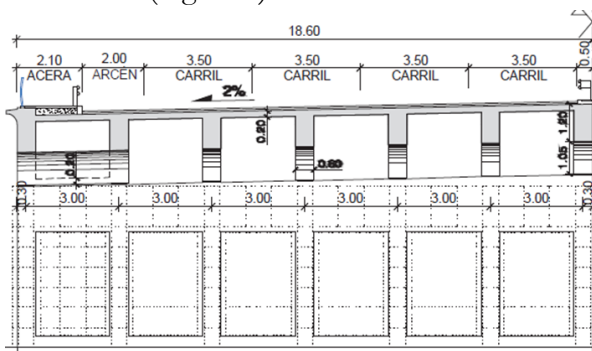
Sección transversal del Puente de la Avenida del Mediterráneo.
